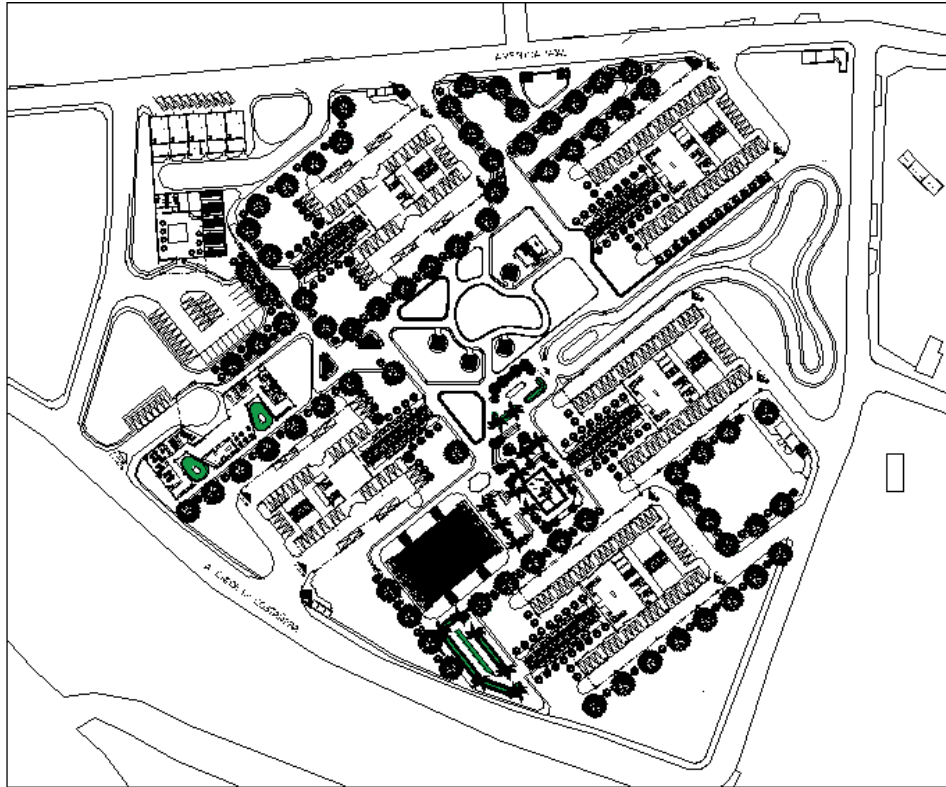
, Plano Conjunto de la residencia. Fuente: El autor (2023).
